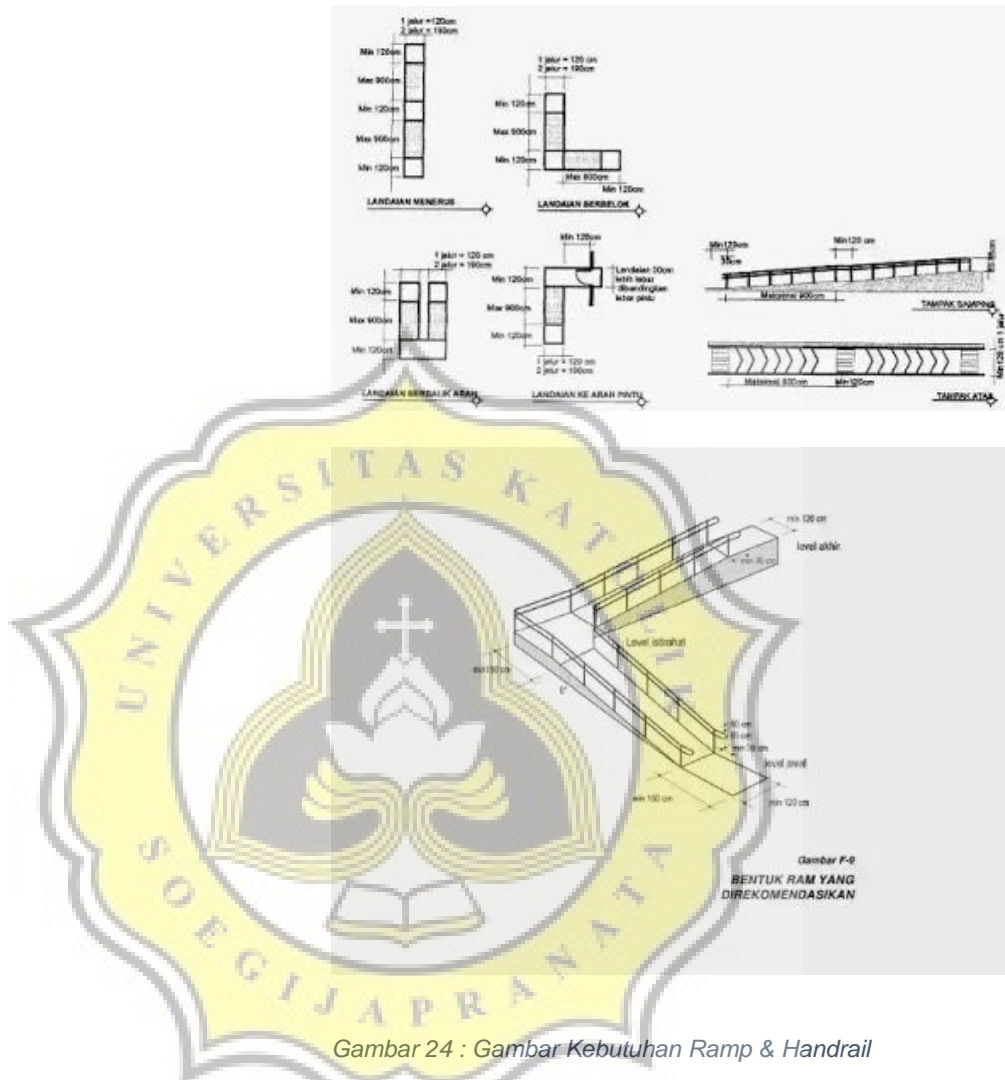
Gambar Kebutuhan Ramp & Handrail
